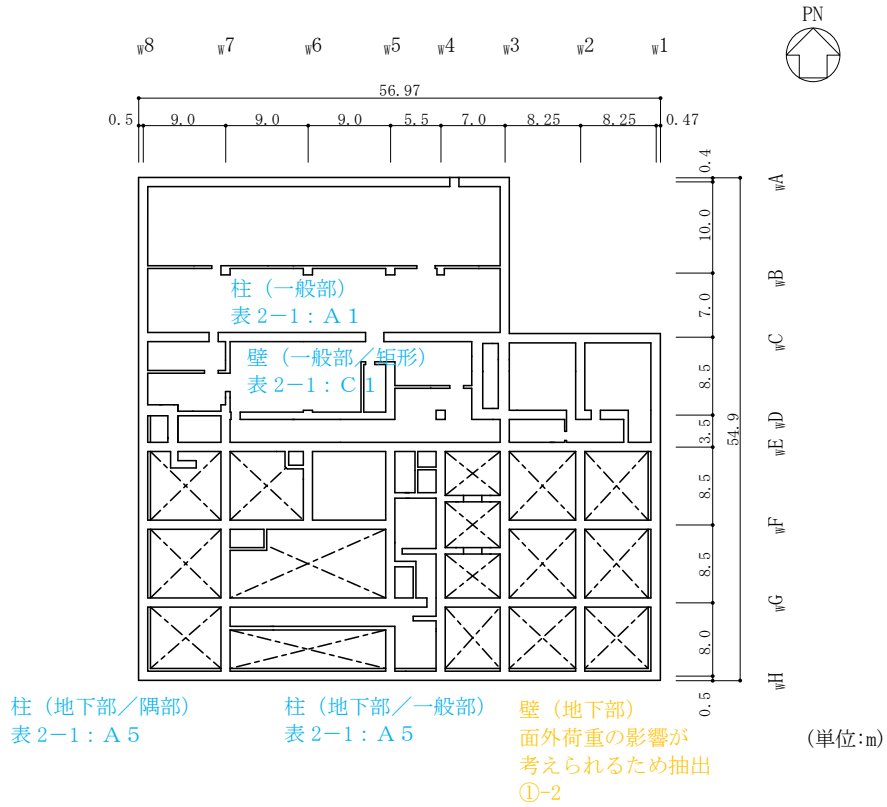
(3) 廃棄物処理建物の概略平面図 (EL 12.3m)
